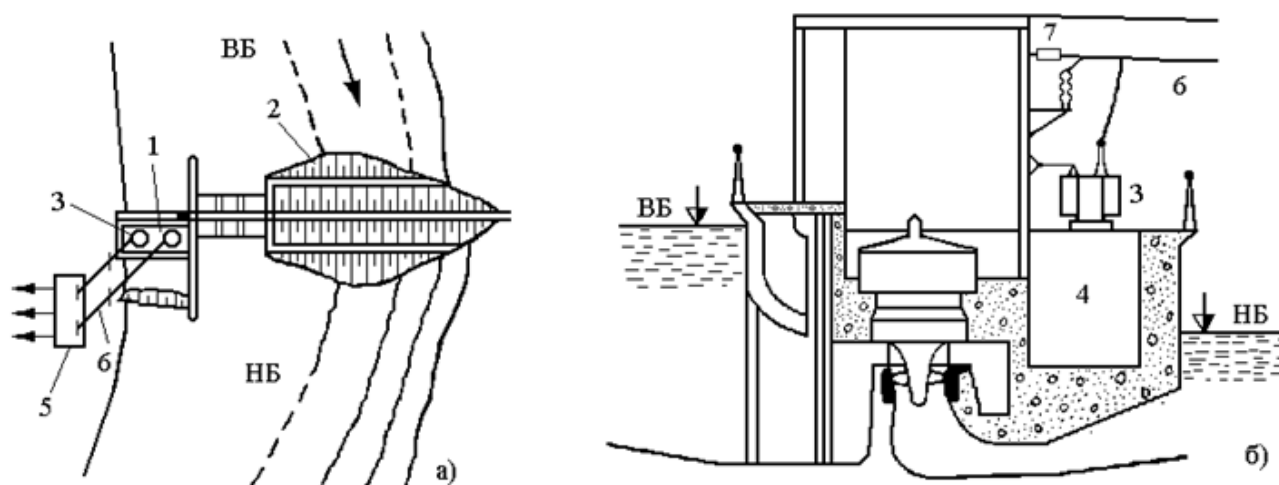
План (а) і поперечний переріз (б) ГЕС, розташованої у руслі
